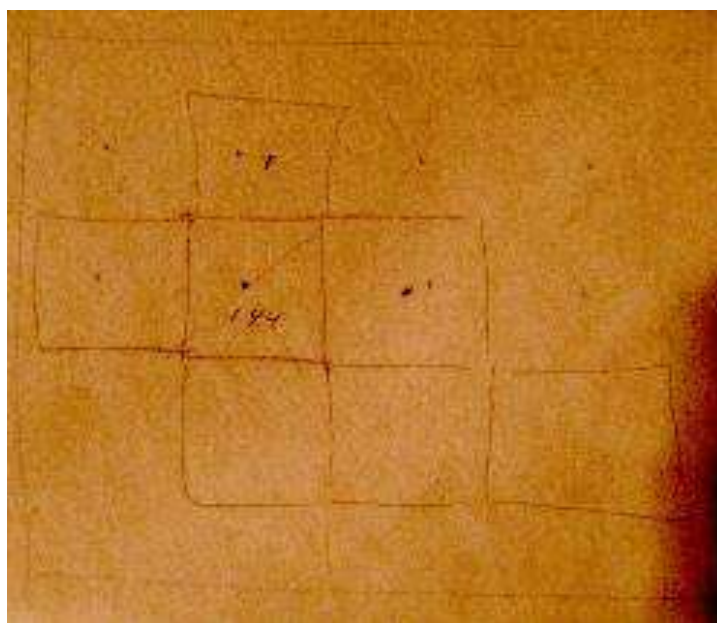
Detalle dibujo repetición de la unidad estructural, la cual, dentro de un orden reticular, da forma al resto del espacio vital de la vivienda.
